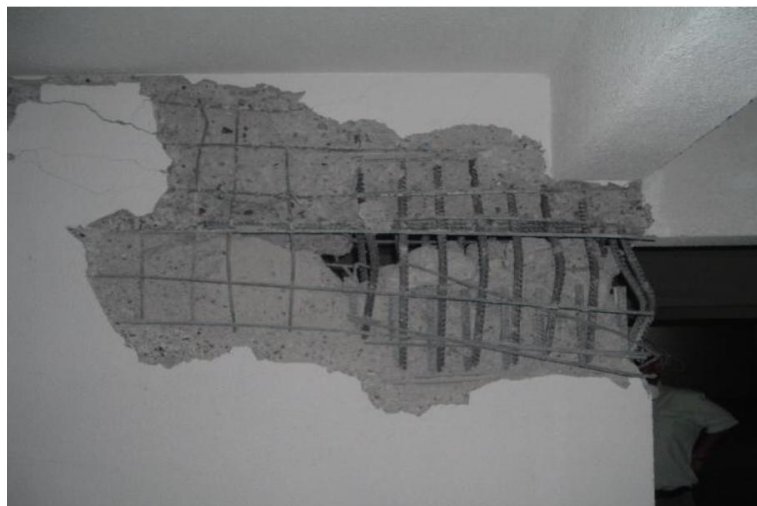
Muro estructural dañado en el subterráneo -1 (Leiva et al., 2010)
